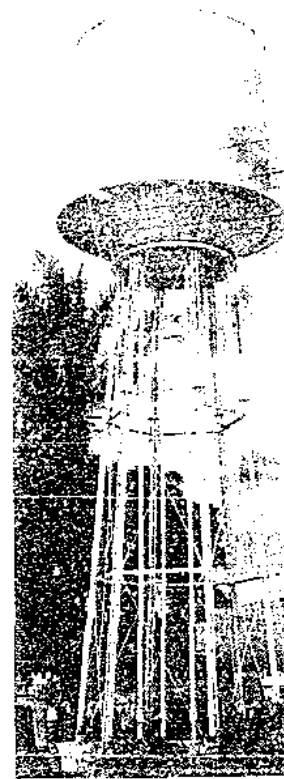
Estanque metálico elevado. Santa Bárbara, Estado Barinas, Venezuela.
